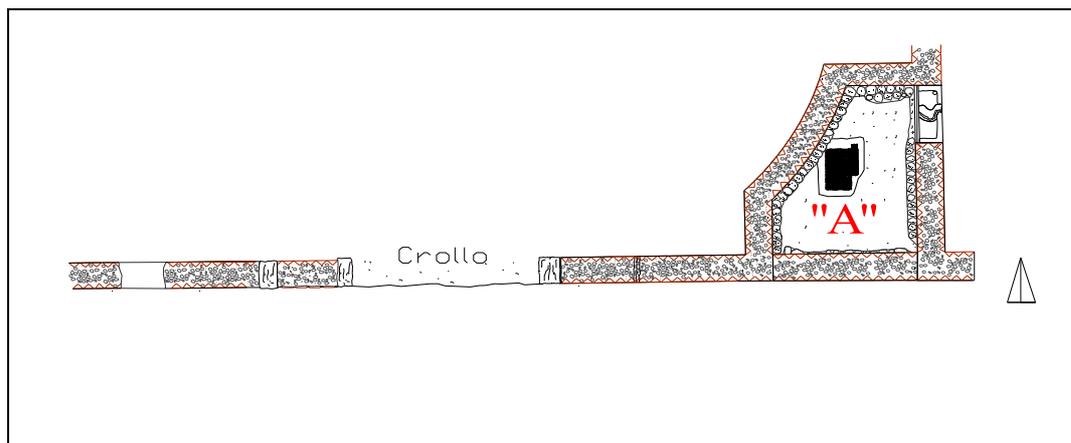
Pianta muro perimetrale sud ed ambiente "A".
